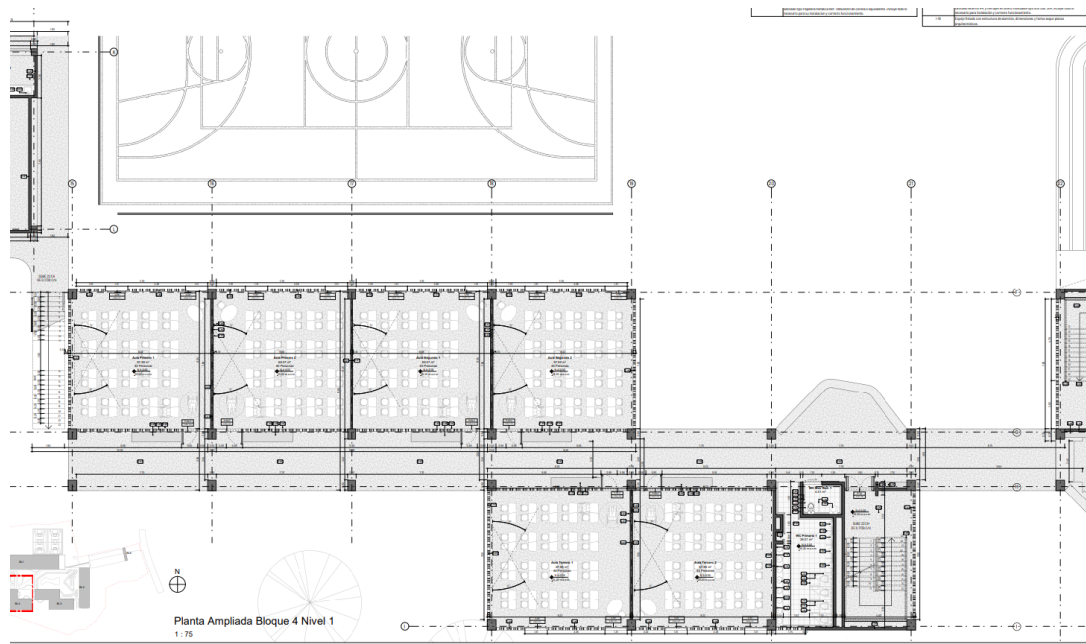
Planos en AutoCAD Bloque 4 (tomado de Fundación Pies Descalzos, 2023)
